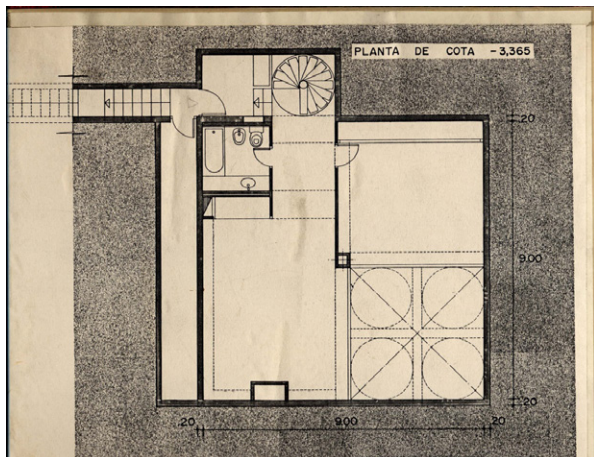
Planta vivienda. Nivel -1 (cota -3,26). Original del proyecto.
